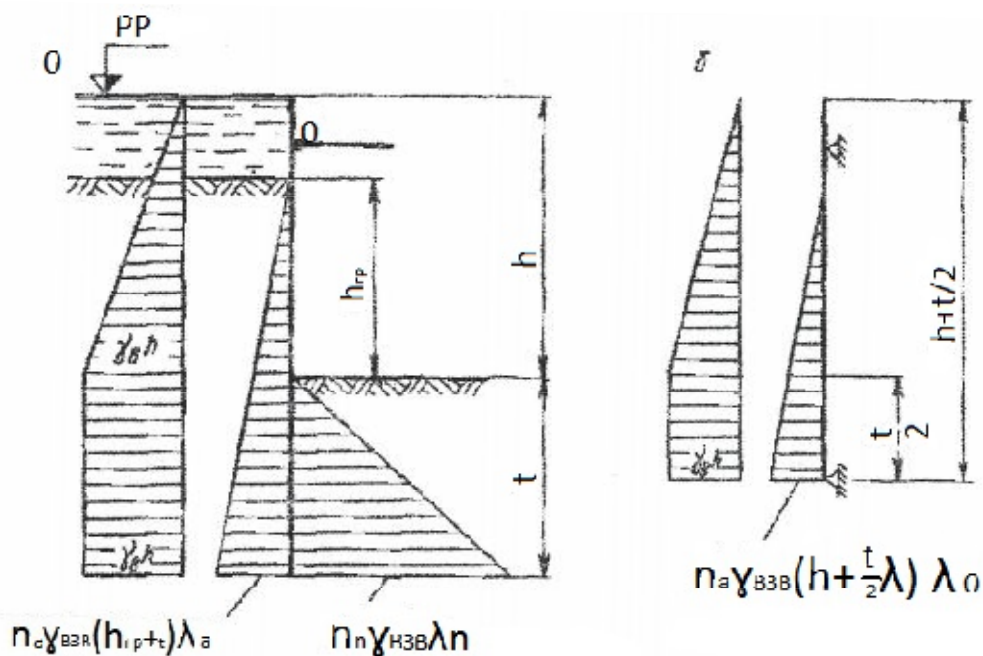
До розрахунку шпунтових огорожень, що не мають розпірних кріплень, у водопроникних ґрунтах із влаштуванням водозахисної подушки
